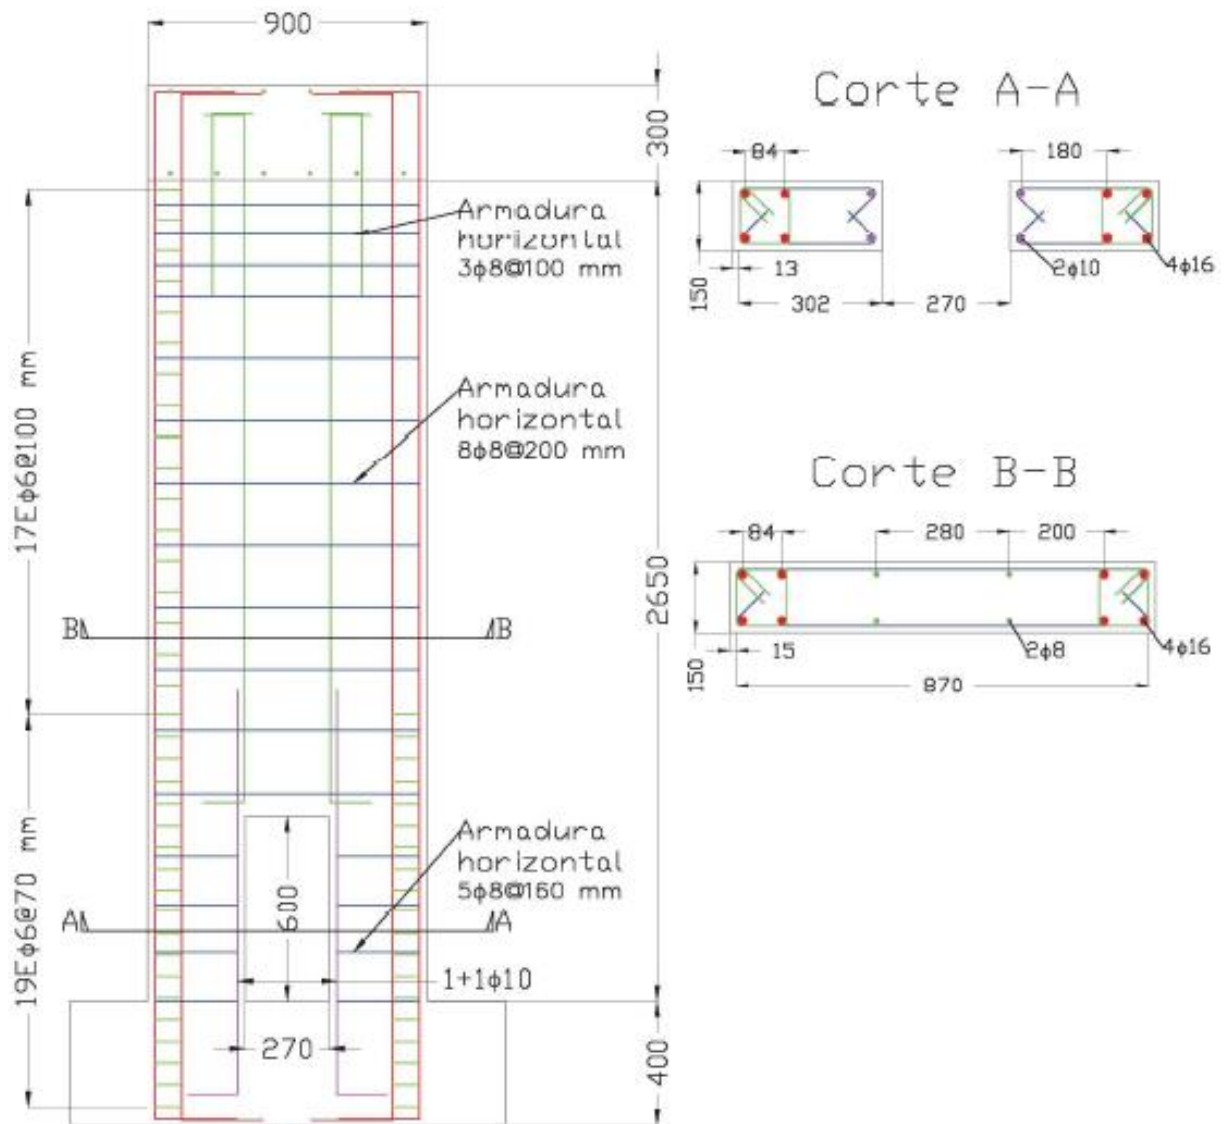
Detallamiento de la armadura de la probeta 3 de muro con abertura.
